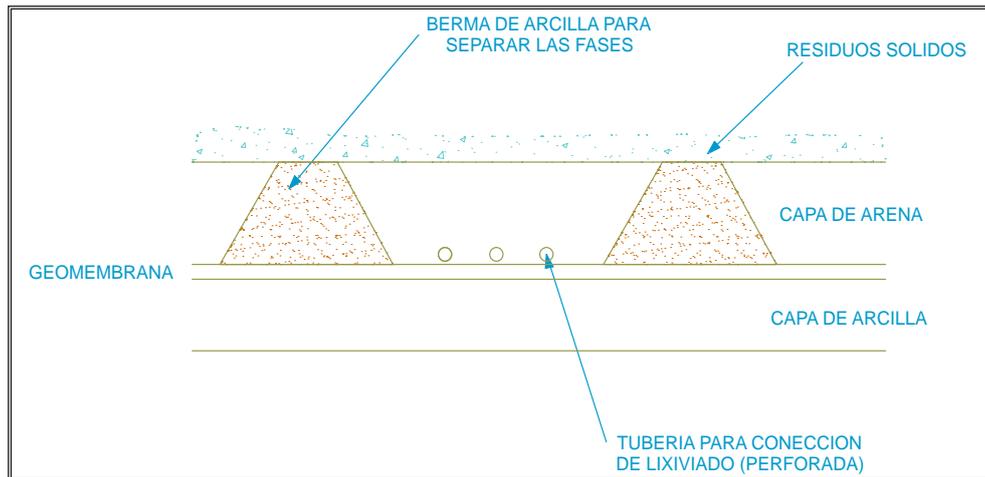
Detalle de una tubería para colección de lixiviado.
